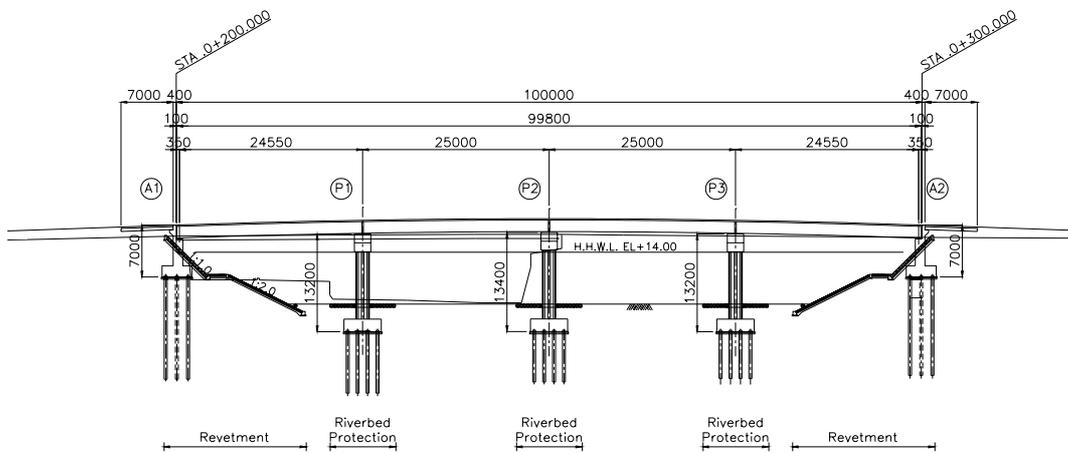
スラコウ橋の護岸工・護床工断面図
